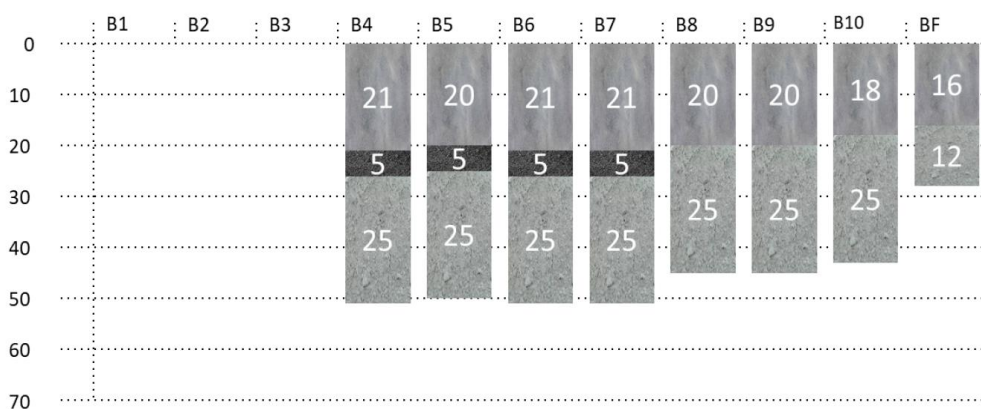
Catálogo de projeto para placas de concreto (espessuras em cm)
